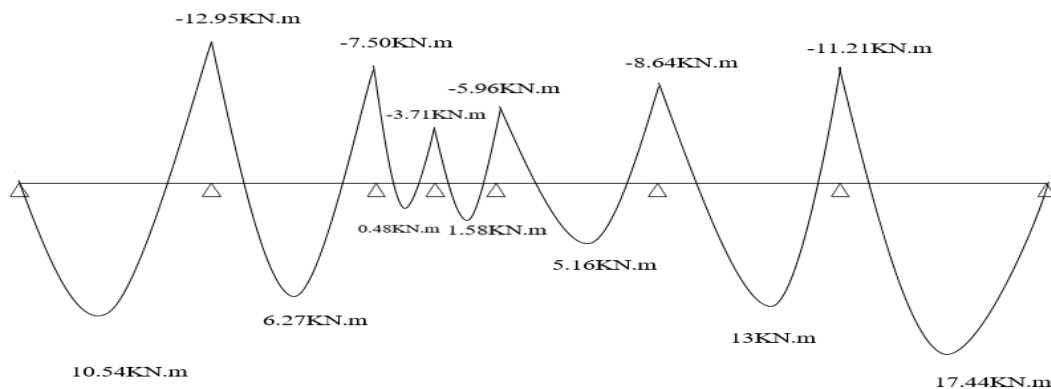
Diagramme de M à l'ELS poutrelle type (RDC+1<sup>er</sup> étage)
